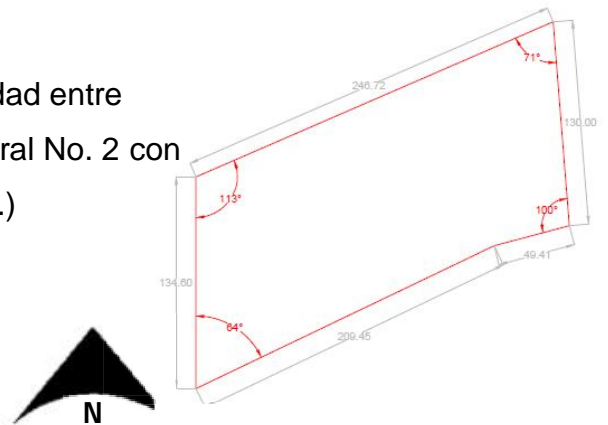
Plano de terreno 1. Fuente Propia s/e. Cotas en m.
